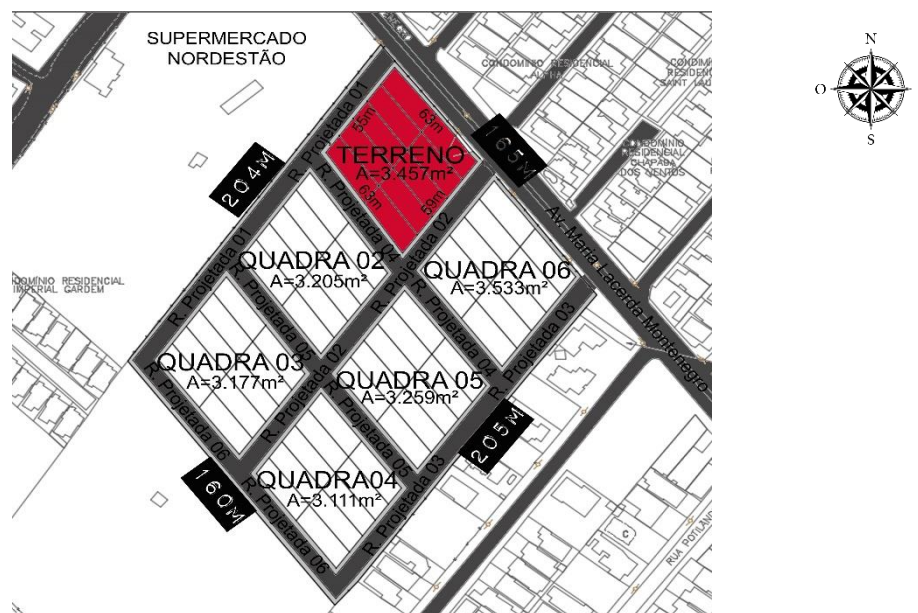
Localização do terreno escolhido para intervenção arquitetônica.
